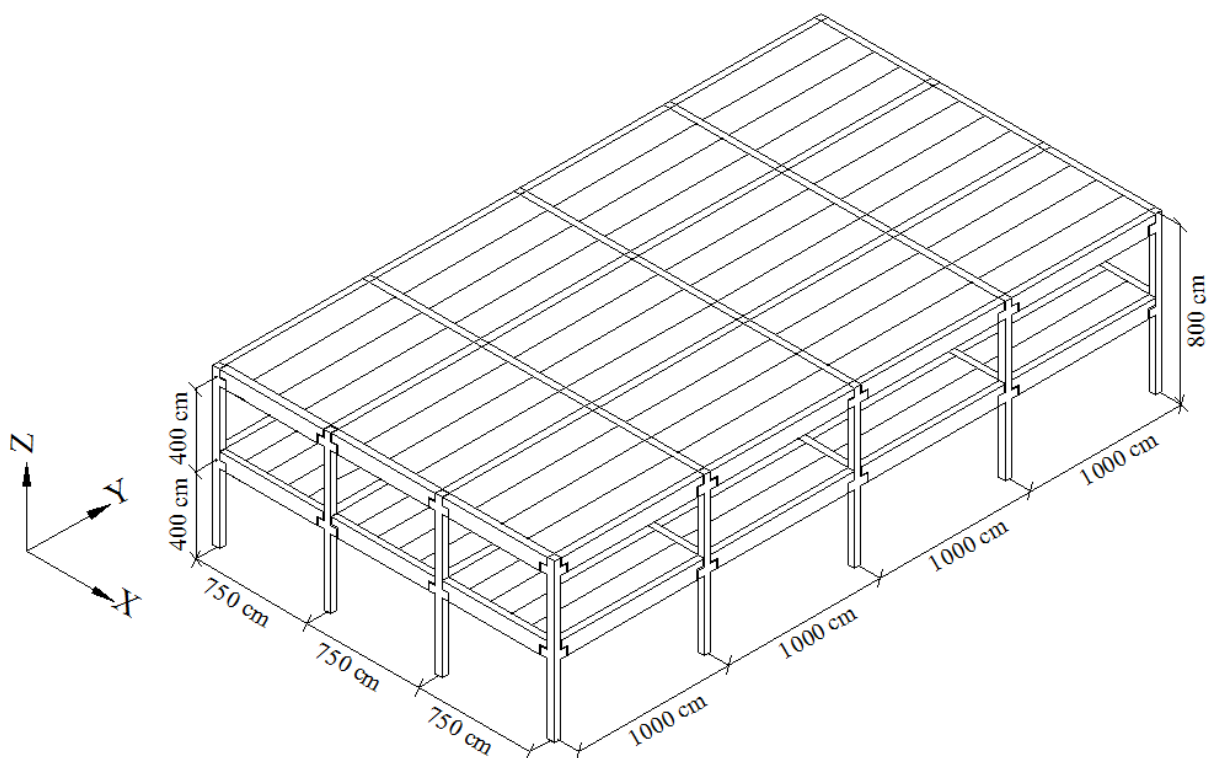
Estrutura em concreto pré-moldado utilizada como exemplo.
